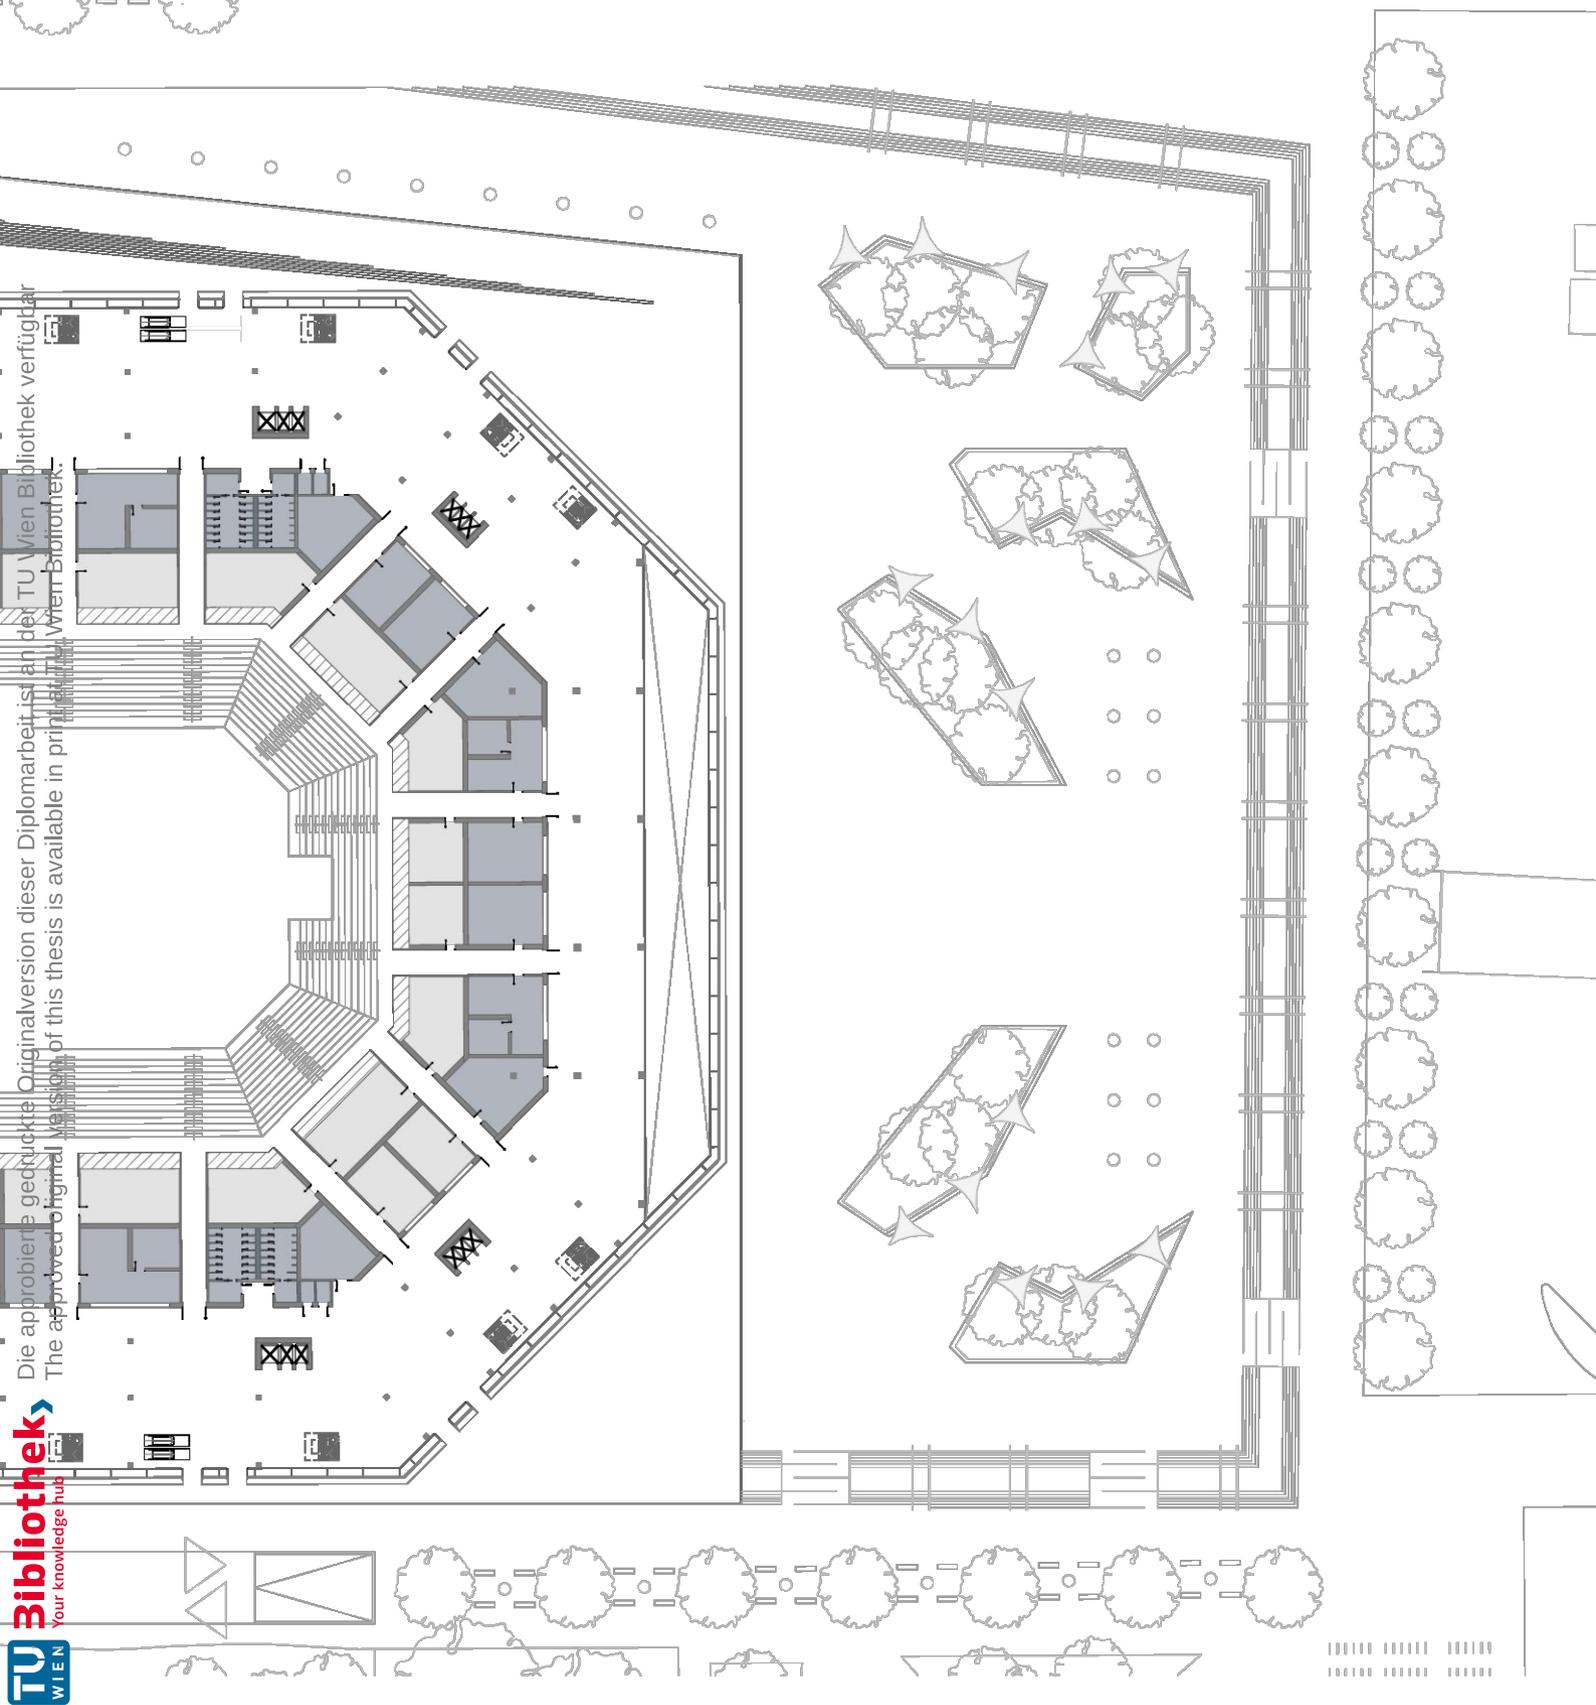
Grundriss 1. OG Gebäudeteilung
